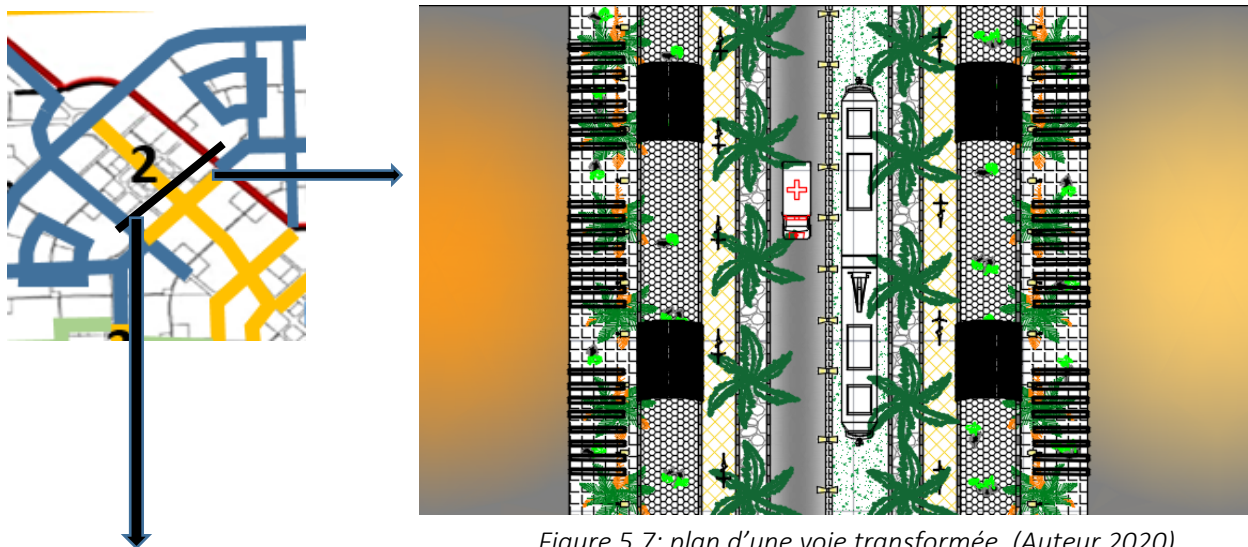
plan d'une voie transformée. (Auteur 2020)
